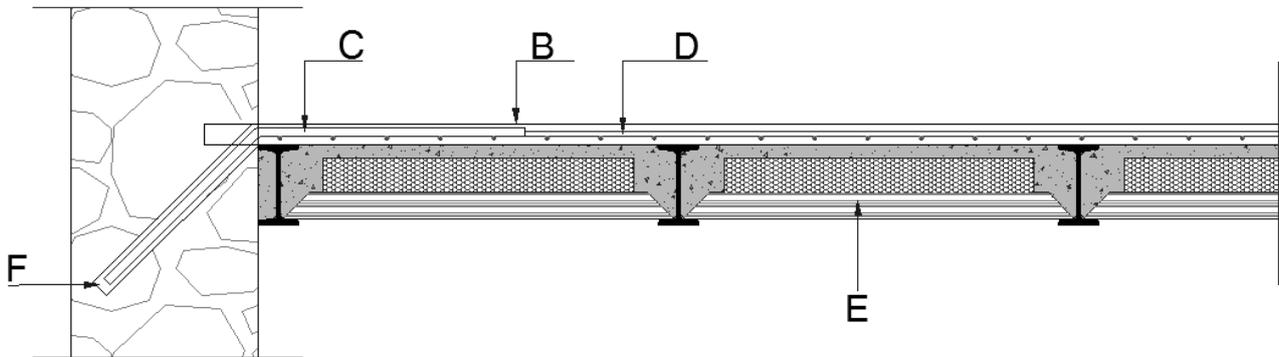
Sezione trasversale con individuazione della volta oggetto di intervento
